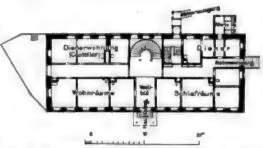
Erdgeschofs-Grundrifs des Rossinischen Baues (1736).
